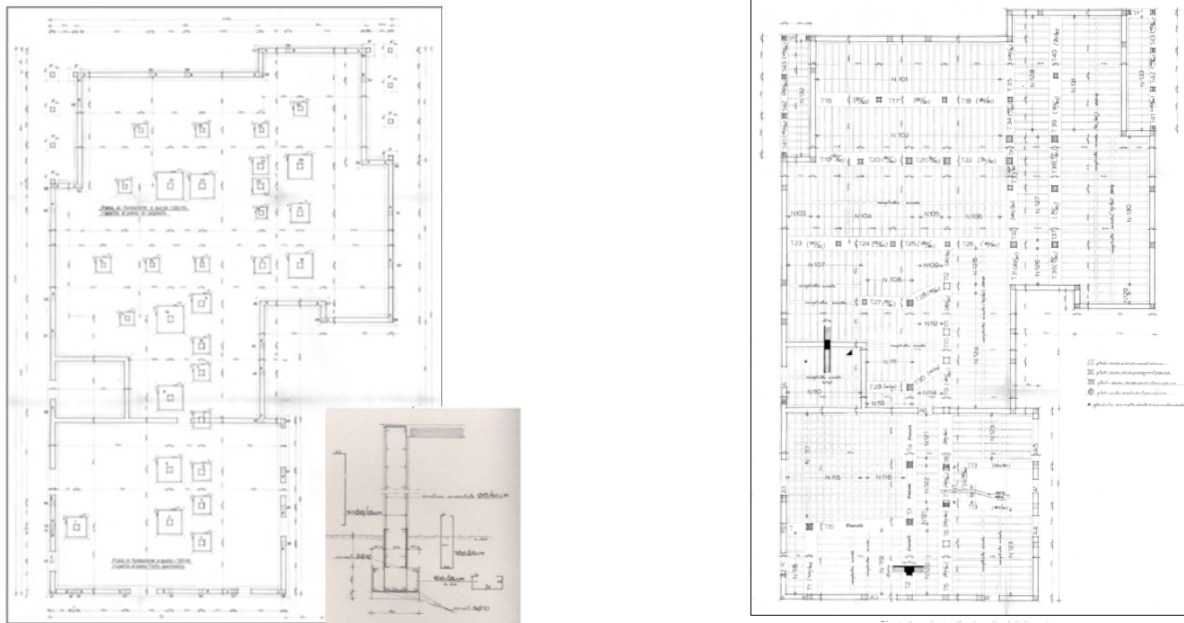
Fondazioni e primo solaio – edificio originario.
